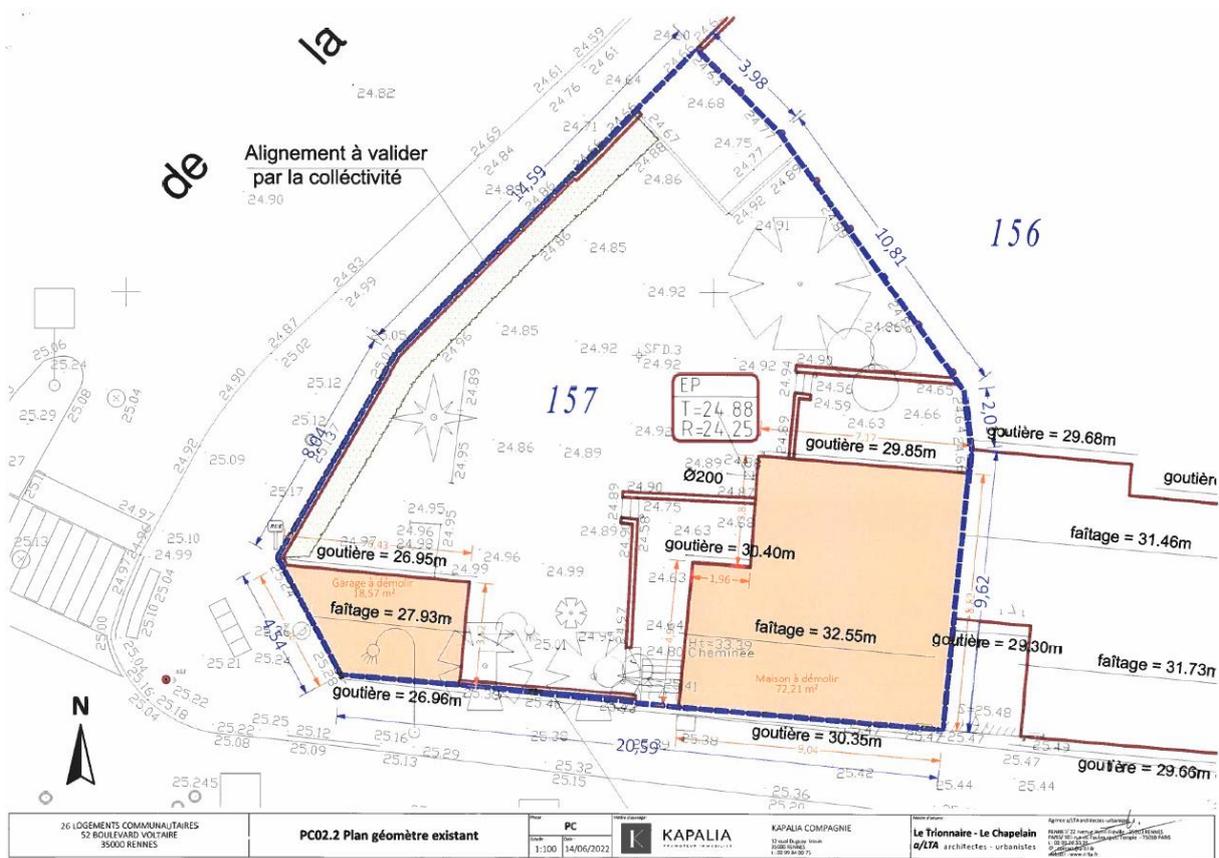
Plan géomètre existant au 14/06/2022 - © ALTA Architecture
